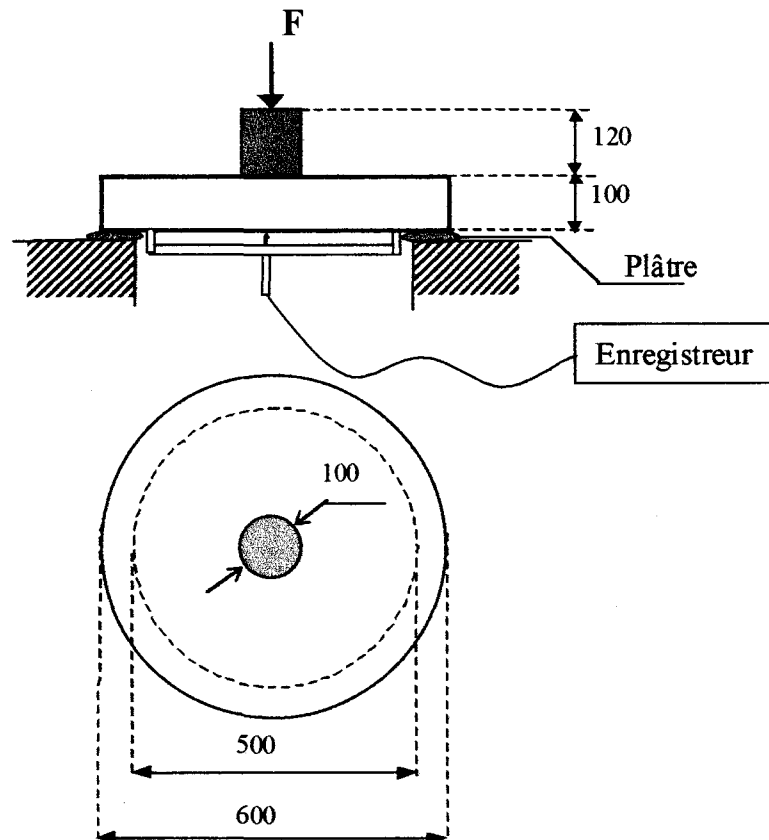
Schéma de l'essai de flexion sur les dalles $\varnothing 60 \times 10$ cm
